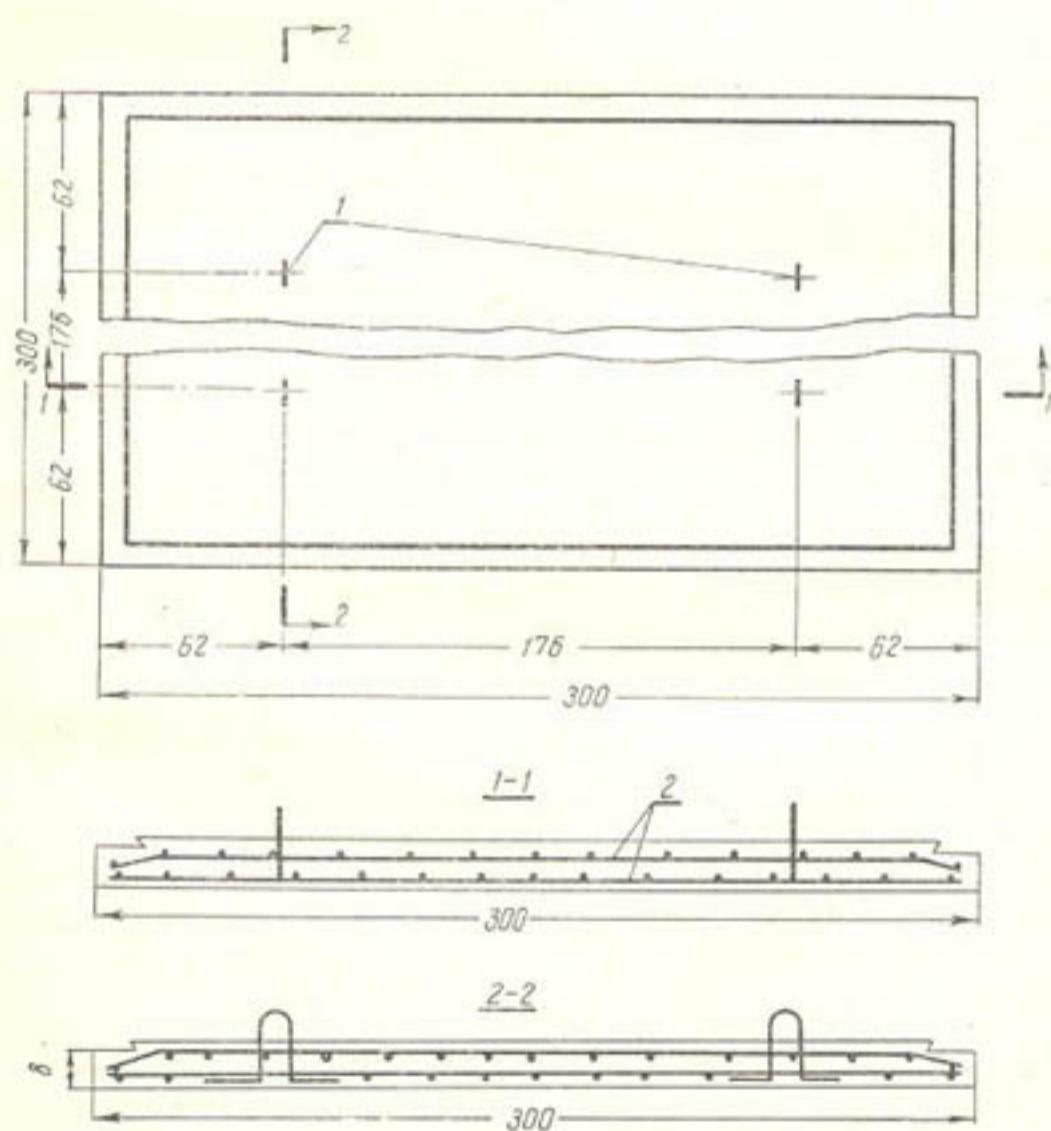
Железобетонная плита для облицовки канала Северский Донец — Донбасс:
